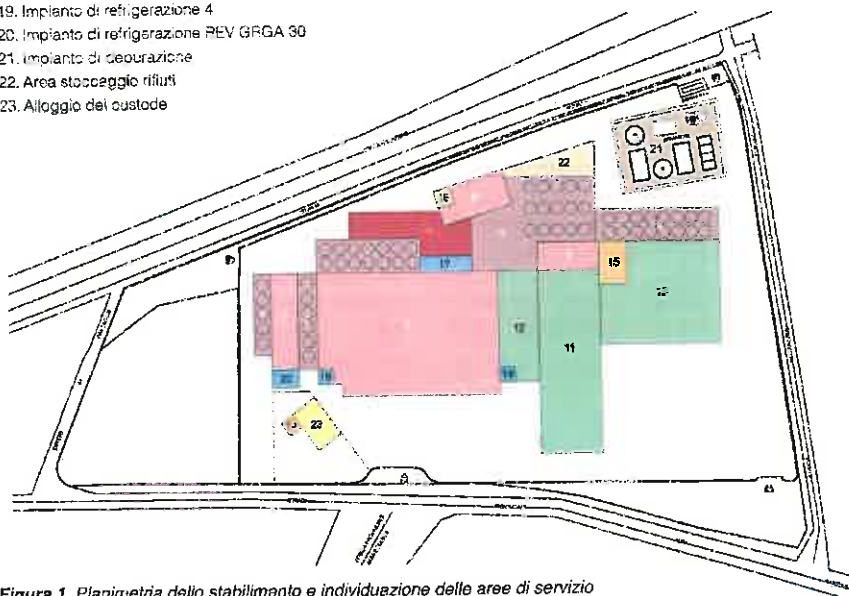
Planimetria dello stabilimento e individuazione delle aree di servizio
